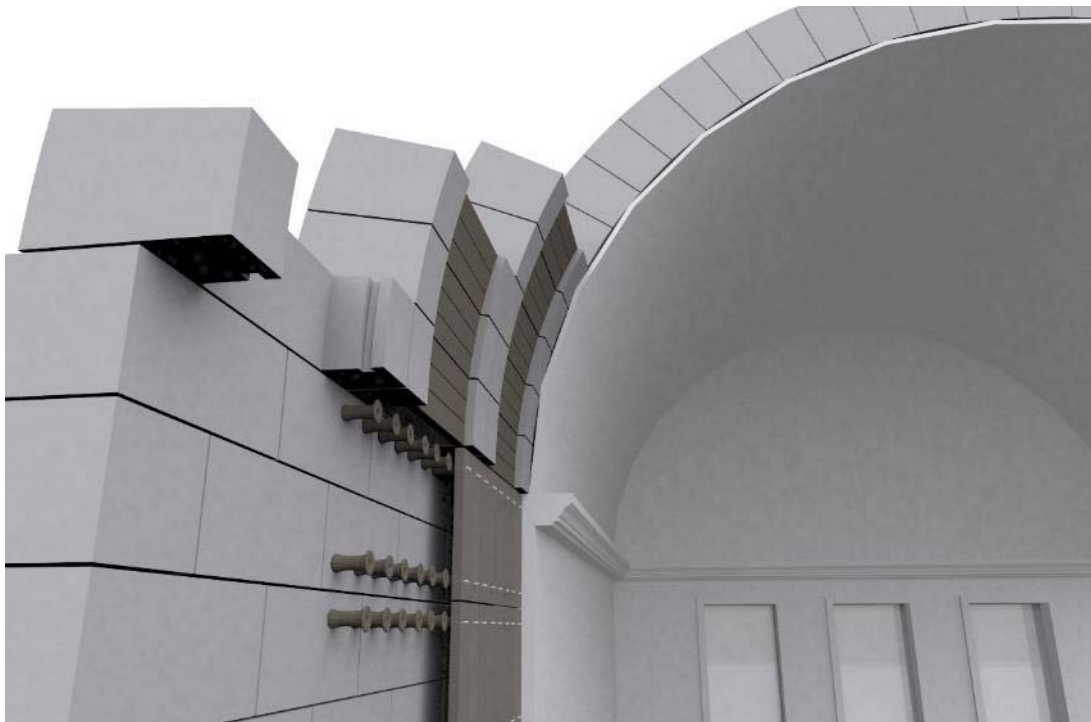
Detalle del encuentro de las *parietales tegula* con las piezas encastradas en las dovelas de la bóveda.
